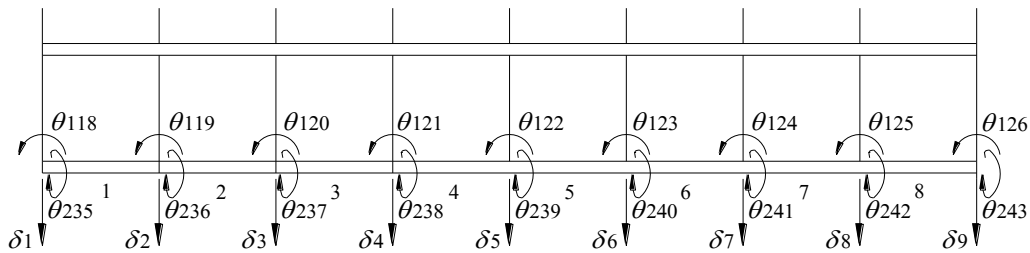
Grados de libertad de las barras de cimentación. (Vista en planta)
